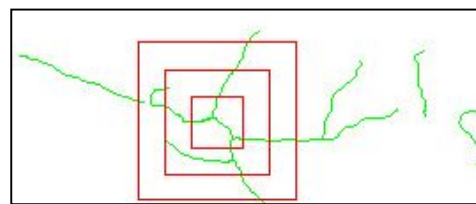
ひび割れ(緑)とメッシュサイズ(赤)の違いのイメージ
